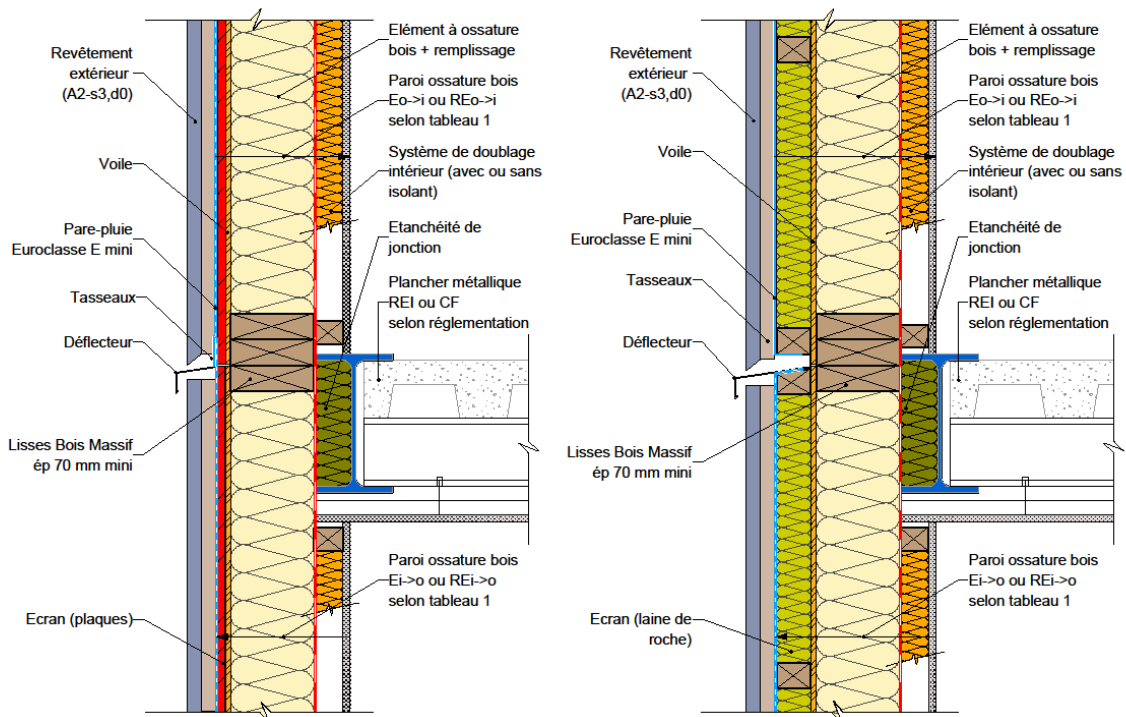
Façade/mur en ossature bois & plancher métallique.
